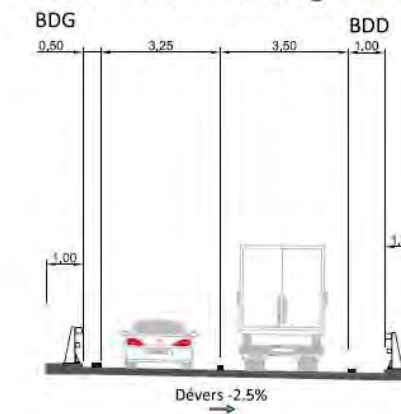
Profil en travers sur l'A86 au niveau de la collectrice, en amont de la bretelle de sortie de l'A86 extérieur – PT ext 4
